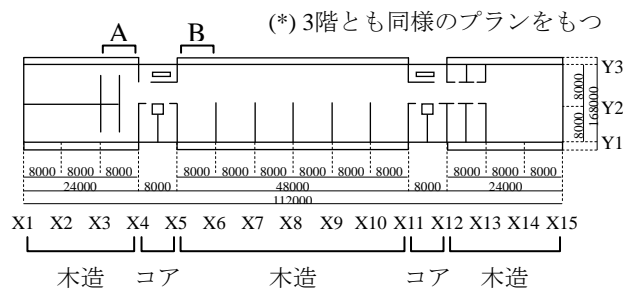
文献1で提示された木質系平面混構造のプロトタイプの平面図
